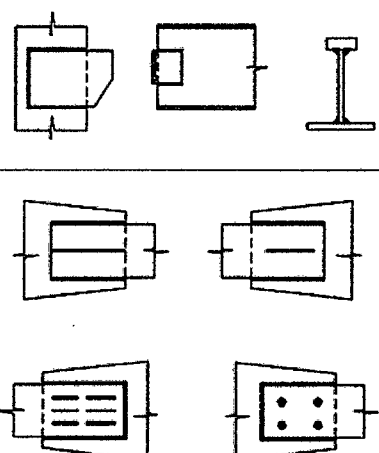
75: Tipos de Posición de Soldadura (McCormac y Csernak, 2012).
